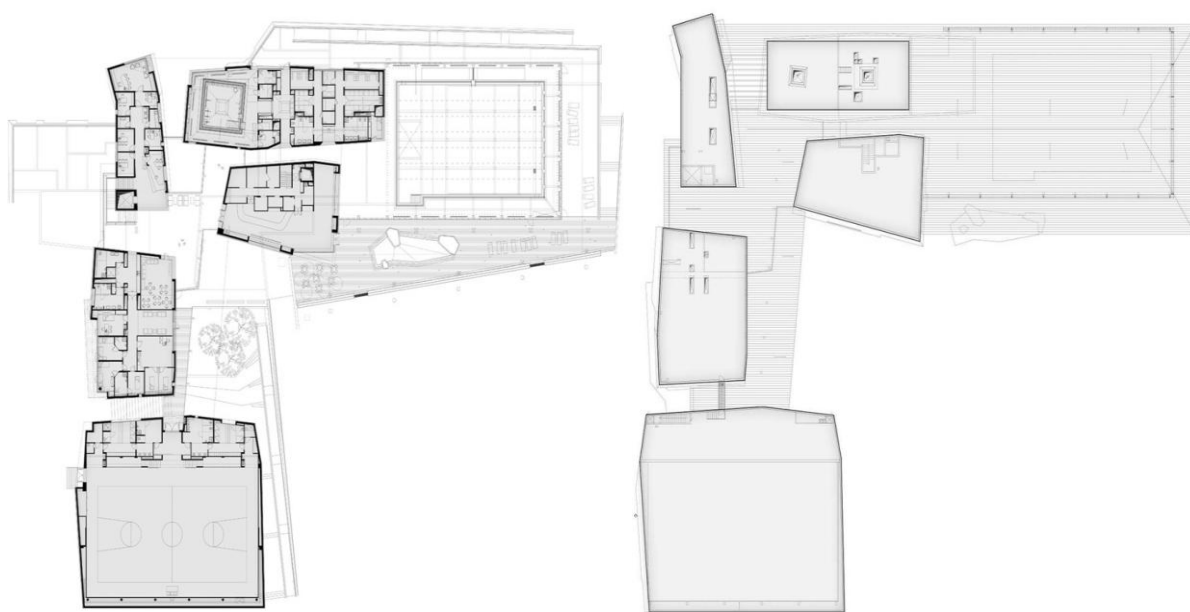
Планування 1-го та 2-го поверхів [34].
